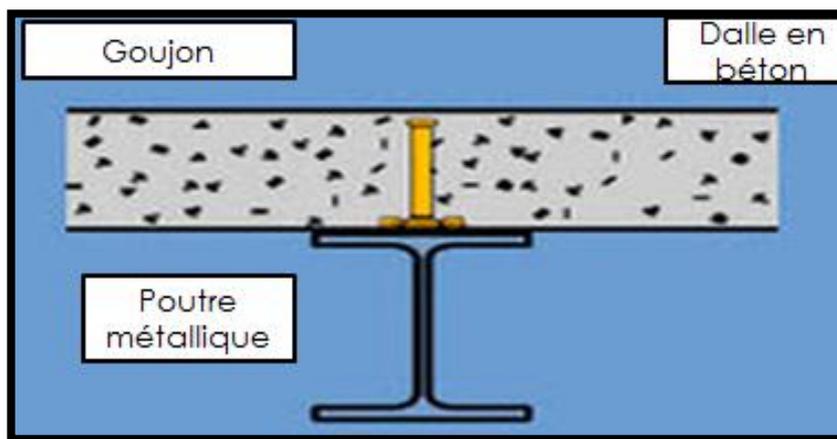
technique d'attachement dalle en béton et poutre en acier
